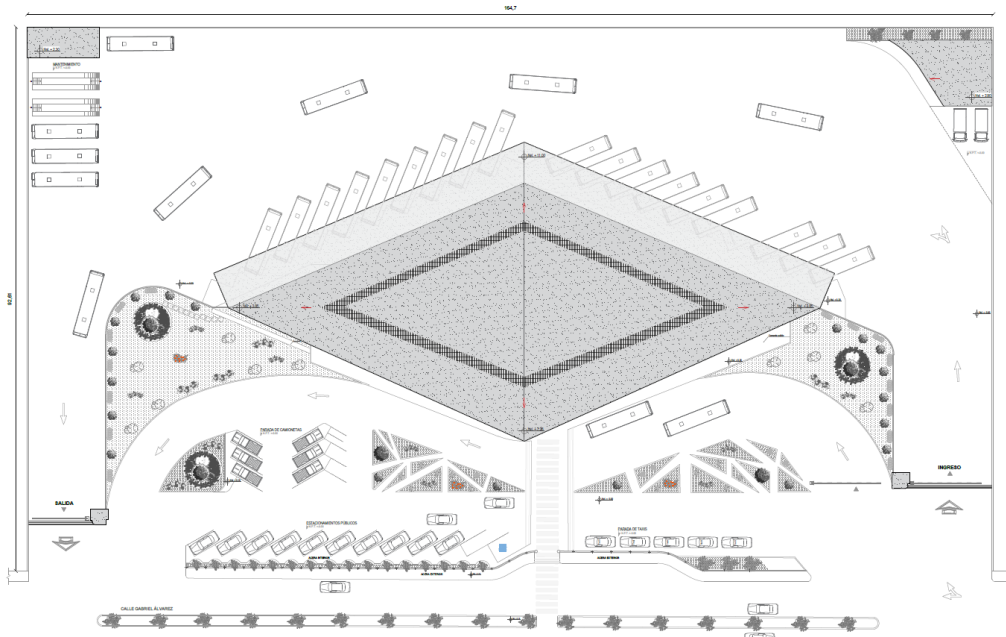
Implantación general Propuesta terminal terrestre Pujilí
